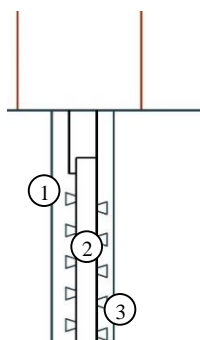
Pormenor construtivo de parede de tabique (Ramos, 2009).
